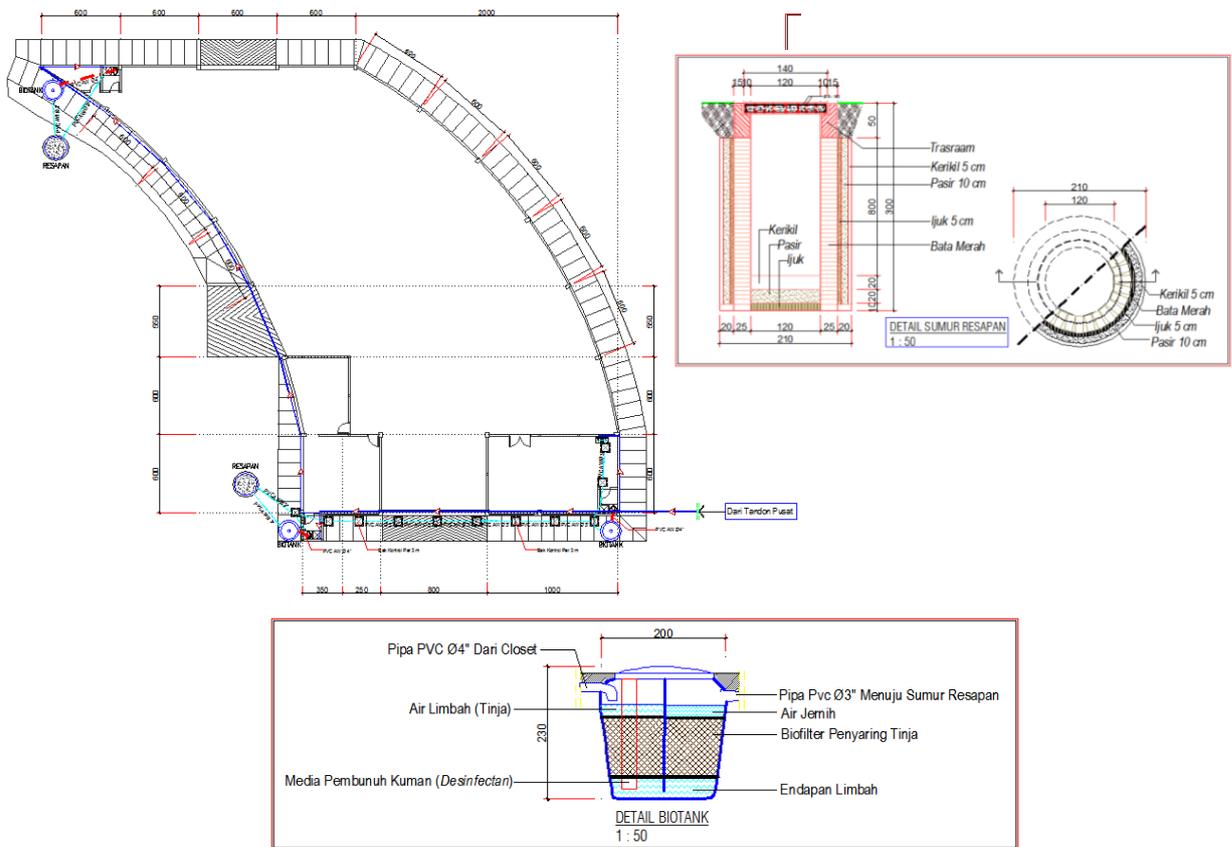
Skema Instalasi Utilitas Gedung Workshop “A”
